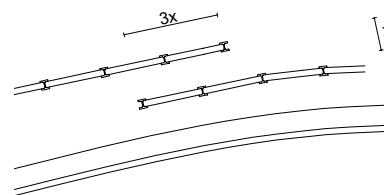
SOLAPE MÍNIMO EN APERTURAS
